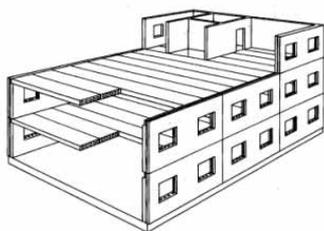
Figura III – estrutura pré-moldada com apoios em painéis portantes de concreto
